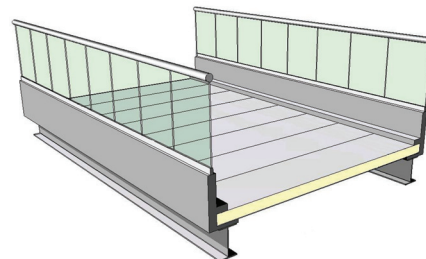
Esquema 3D de ponte pedonal com tabuleiro em painéis sanduíche
